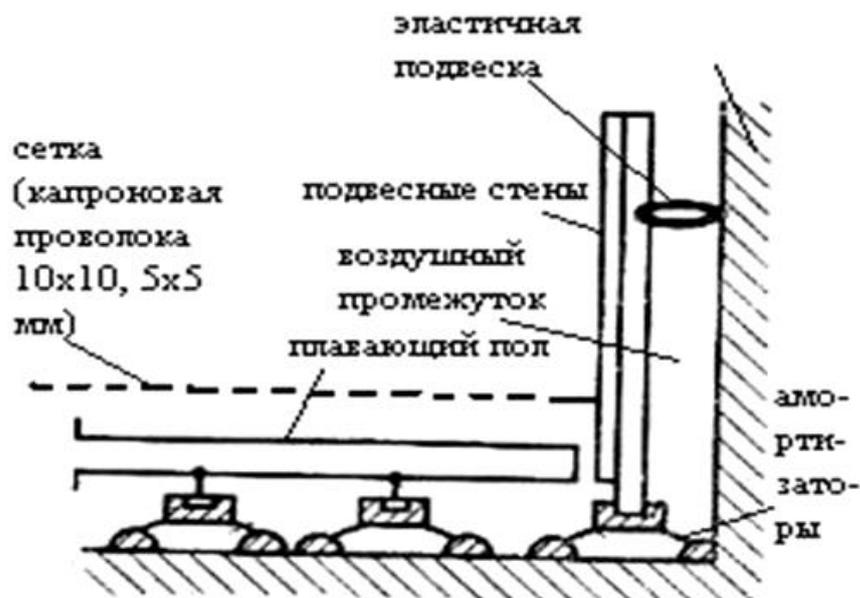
Схема конструкций пола и стен заглушенной камеры
